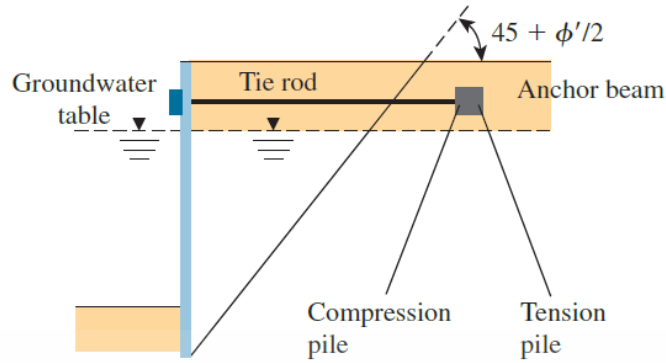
กำแพงกันดิน Piling wall [24]
